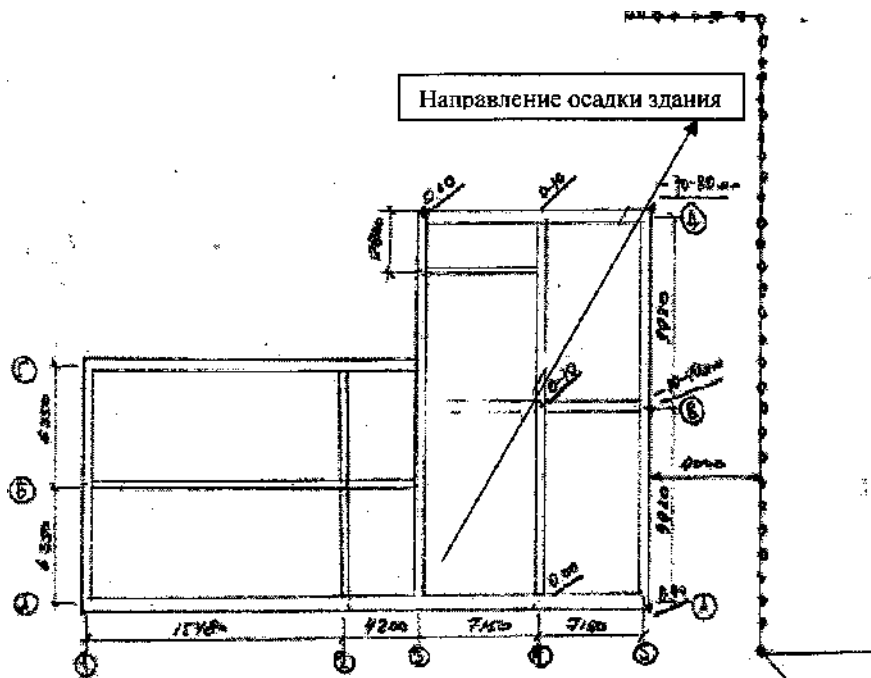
Схема осадки здания в плане, выполненная на месте обследования.
